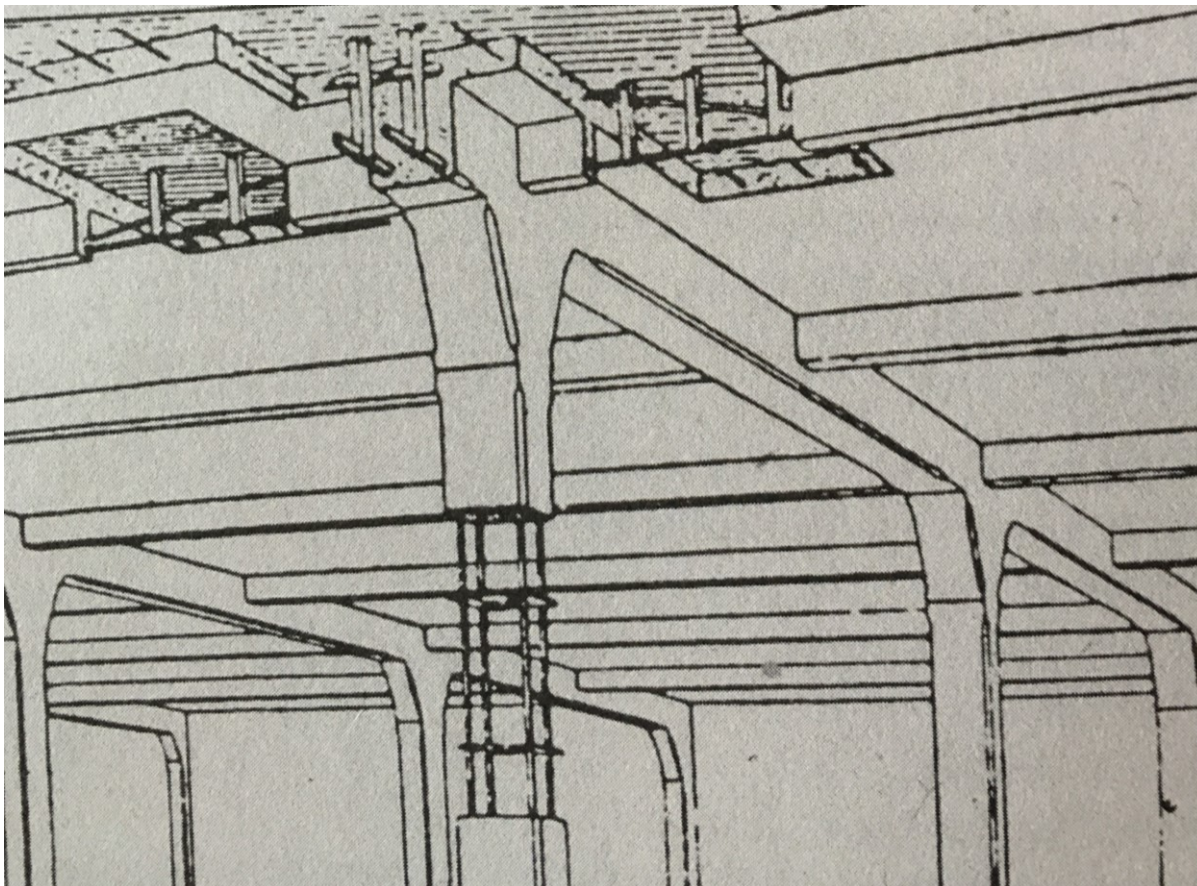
Sistema de betão armado Hennebique. 1892. (Collins, *Concrete. The vision of a new architecture*, 2004, p. 34)
